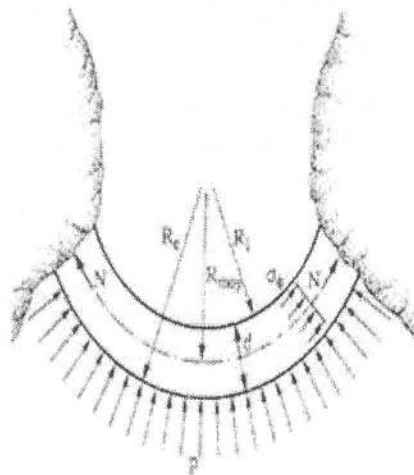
Vue en plan de l'arc circulaire d'un barrage-voûte
